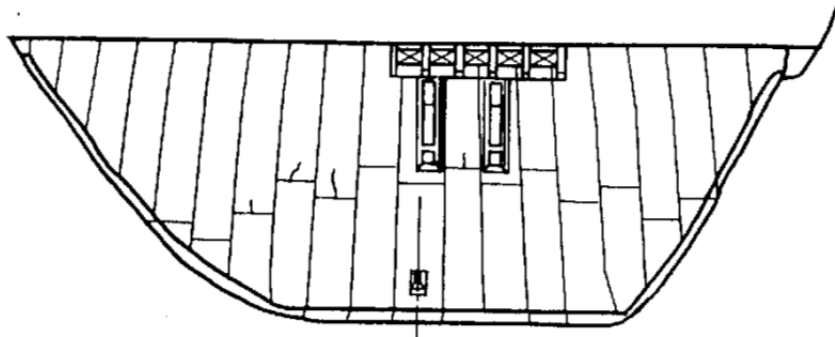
長期打止めへ打ち継いだコンクリートに発生したひび割れの例¹⁾
